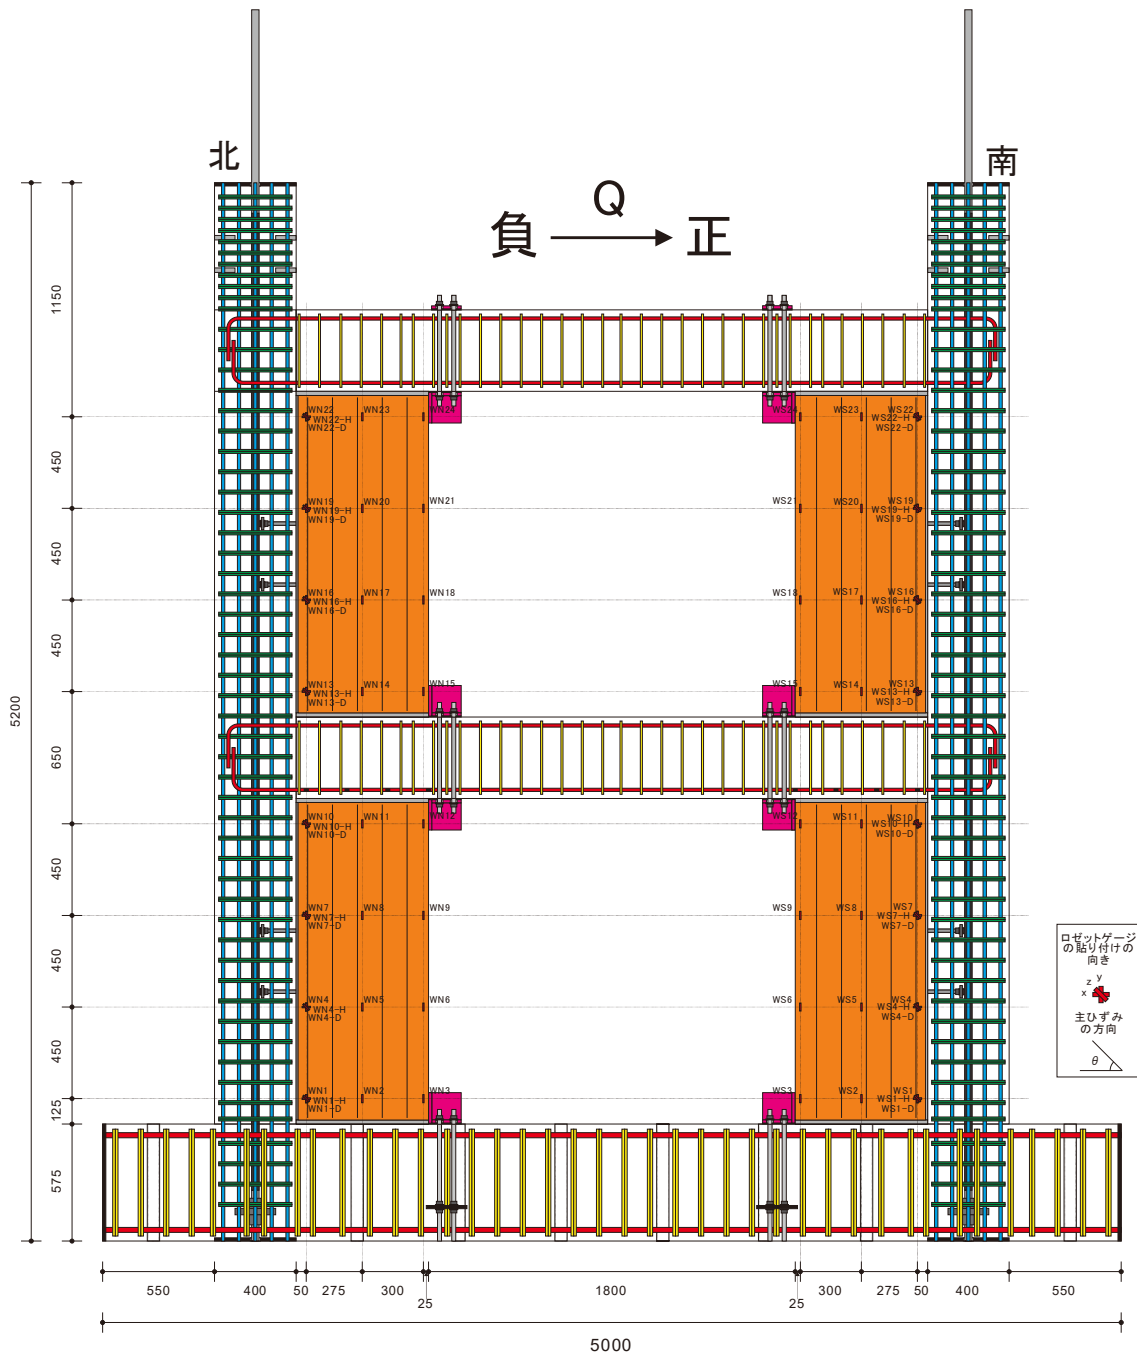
試験体 B の袖壁に貼付したひずみゲージの位置 (単位 : mm)
